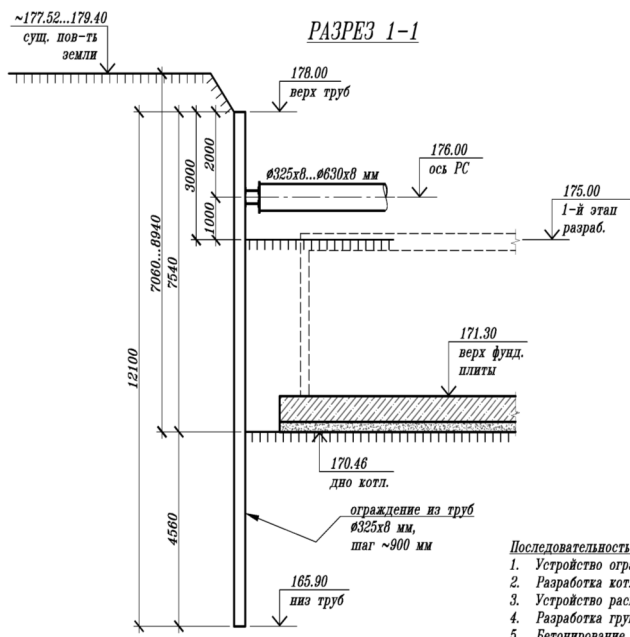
Поперечный разрез 1-1 в наиболее нагруженном участке ограждения котлована для труб Ø325х8
